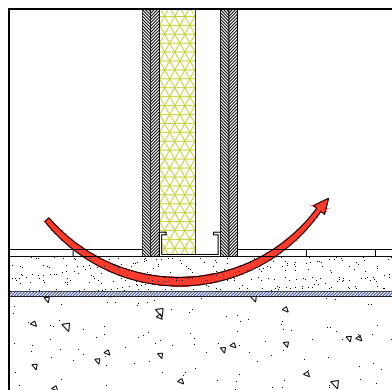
esempio di trasmissione strutturale dovuta alla continuità del massetto alla base della parete divisoria (assenza del giunto di separazione)
